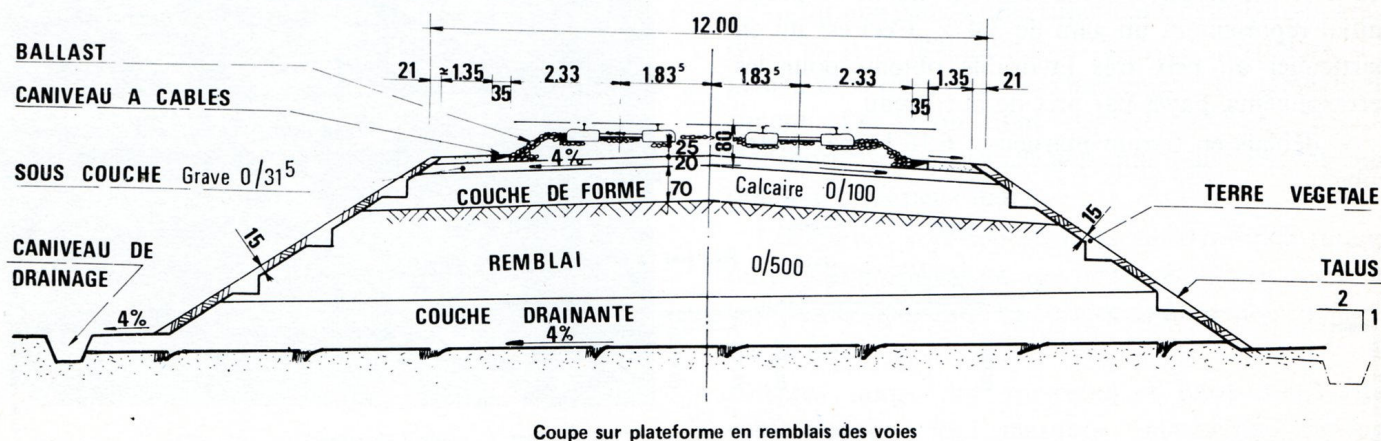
Tunnels de La Pommeraye et de Marnay. Coupe sur plate-forme en remblai.
